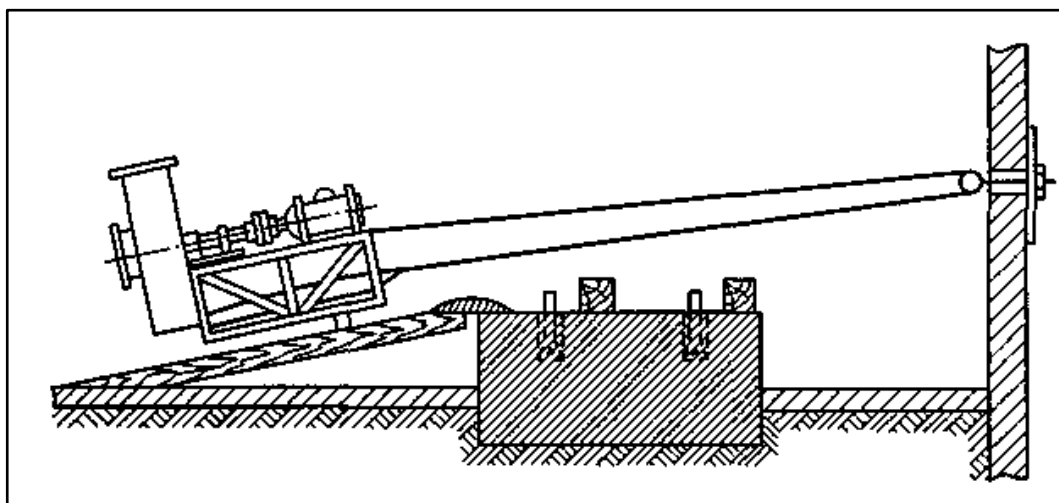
Пример строповки вентиляторов при установке его на фундамент
